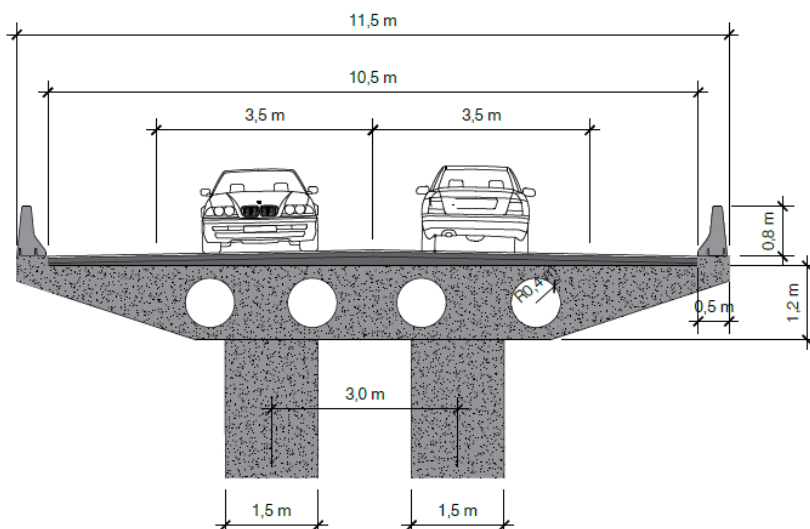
Sección tipo para los puentes introducidos en el trazado de la vía proyectada.
